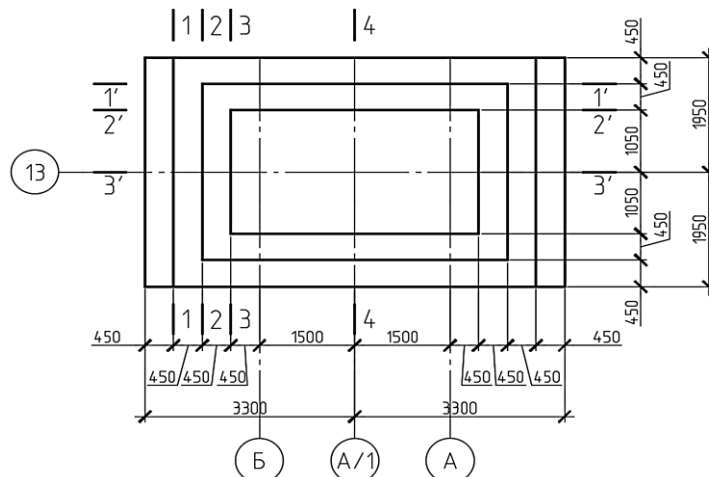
Схема до розрахунку арматури плитної частини фундаменту
